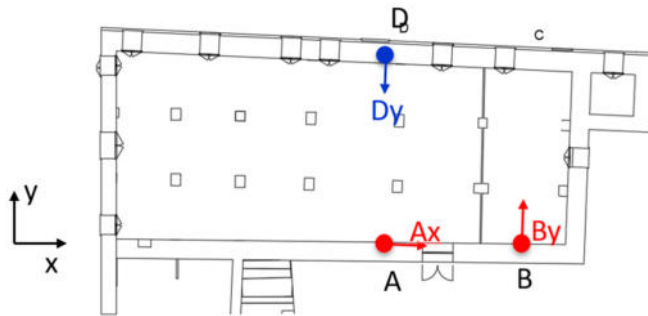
Disposizione degli accelerometri nel piano terra dell'edificio.
